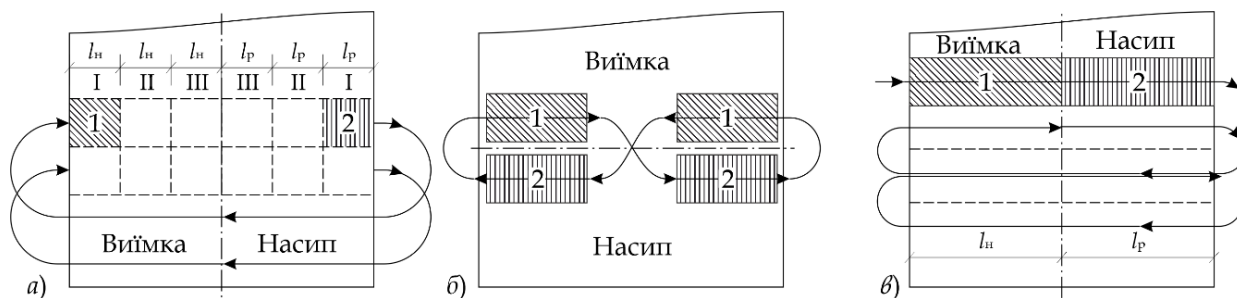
Схеми руху скрепера при плануванні майданчиків:
